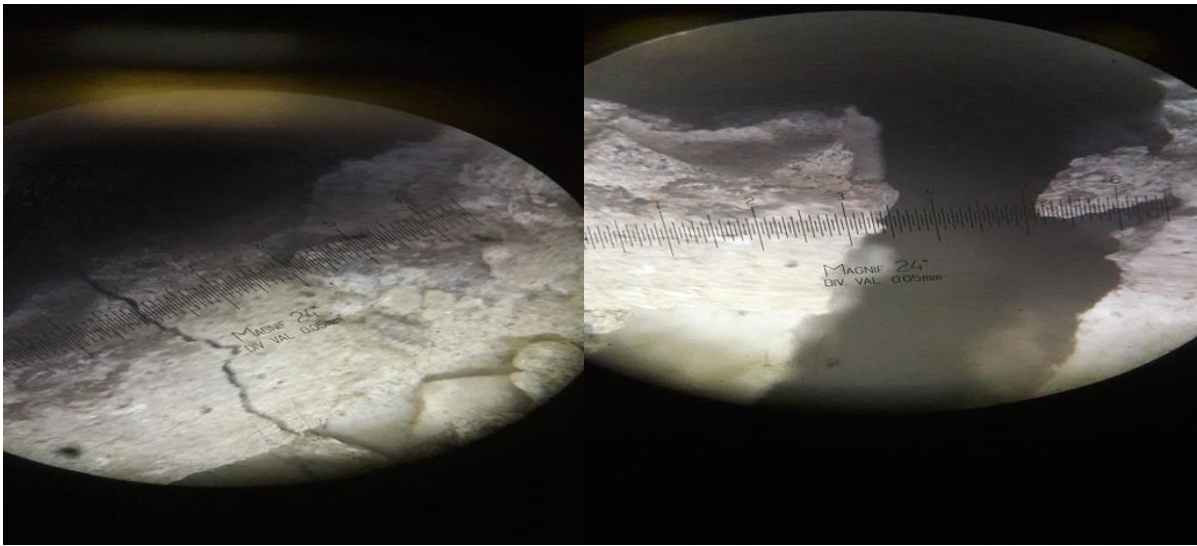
Première fissure sur la poutre armé Figure III 18 dernière fissure sur la poutre armé
